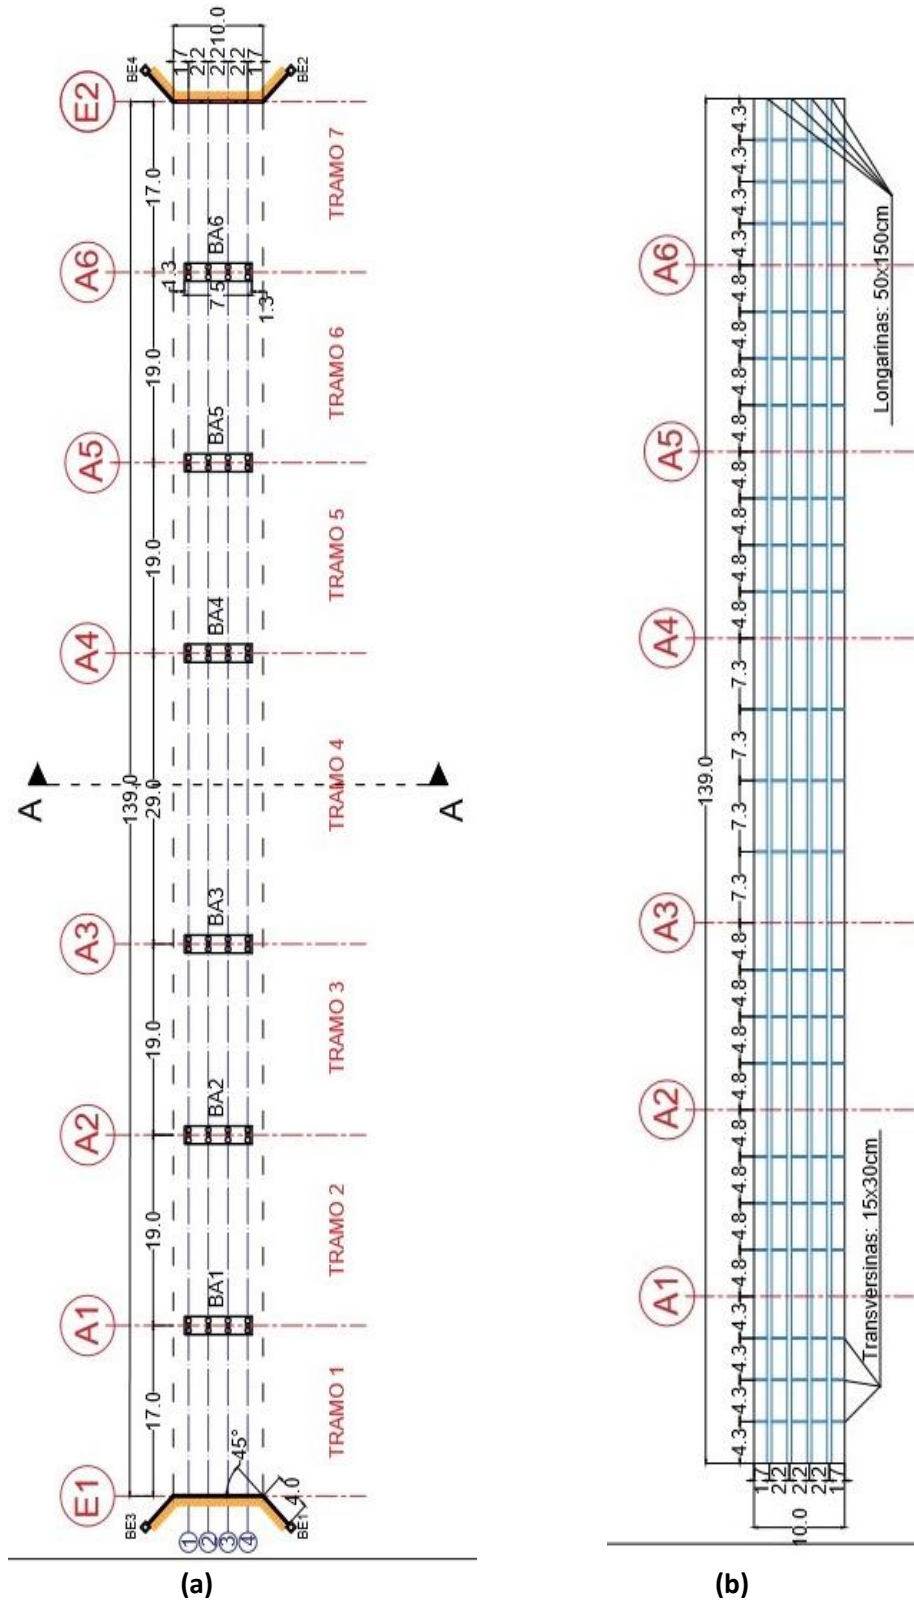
Planta baixa de locação dos blocos (a) e tabuleiro (b)
